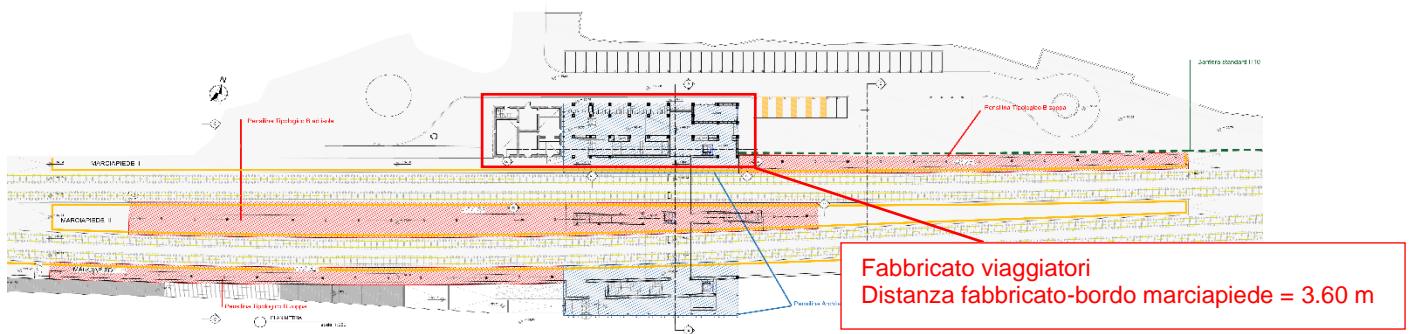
Planimetria d'insieme della stazione di Anguillara
